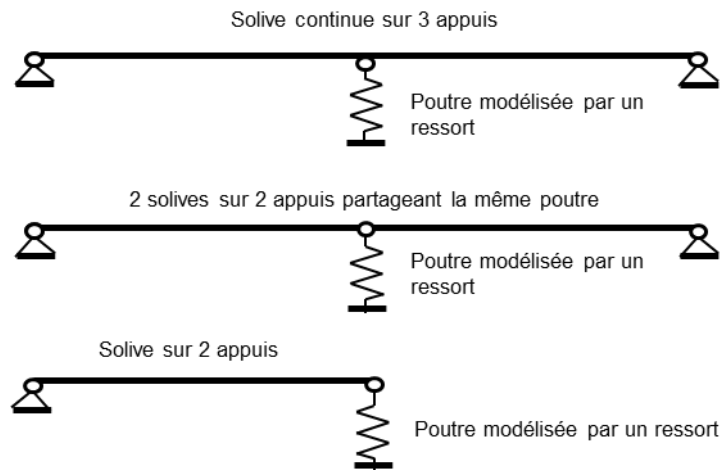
Modélisation d'une solive appuyée sur une poutre d'un côté
